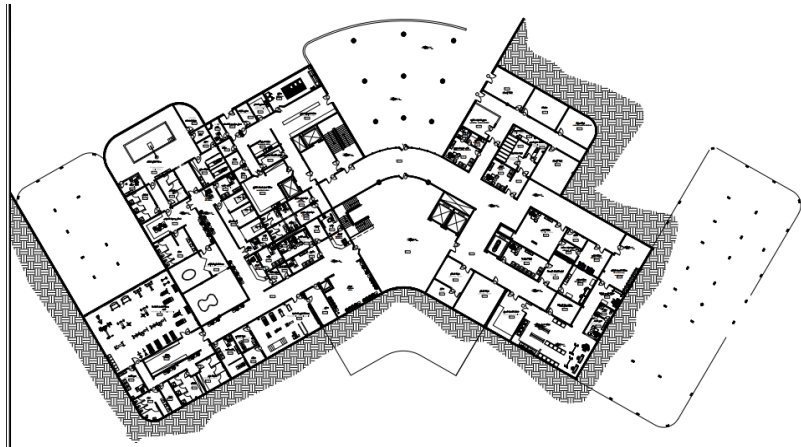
يوضح مسقط الطابق الارضي للمبنى
